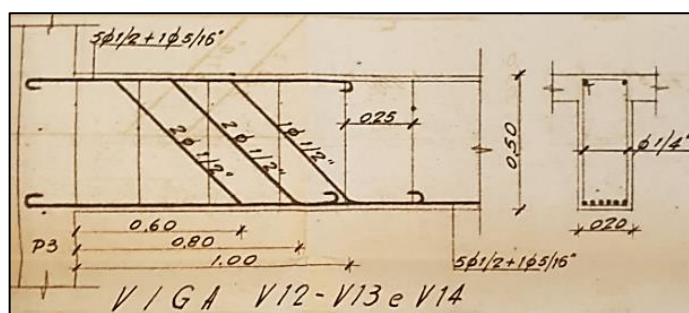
Pormenorização das vigas no projeto de estruturas do edifício tipo disponível no Arquivo Municipal
